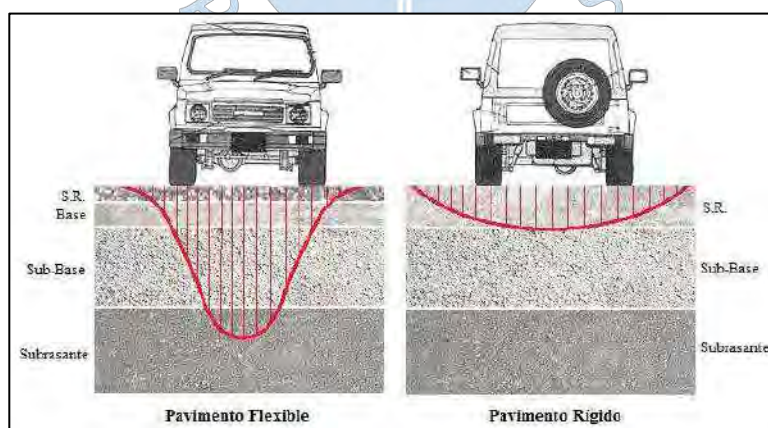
Distribución de esfuerzos en pavimentos flexibles y pavimentos rígidos.
